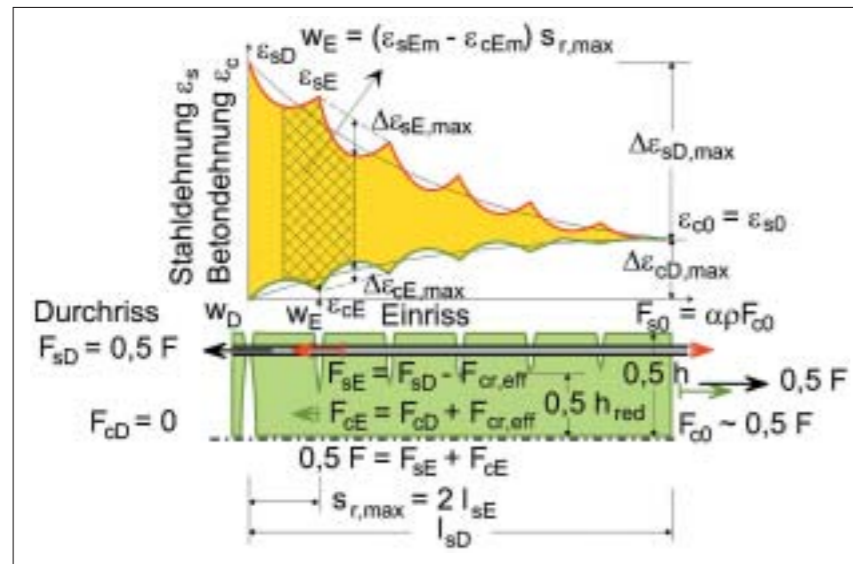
Rissmechanismus eines dicken symmetrisch bewehrten, zentrisch gezogenen Betonstabs
